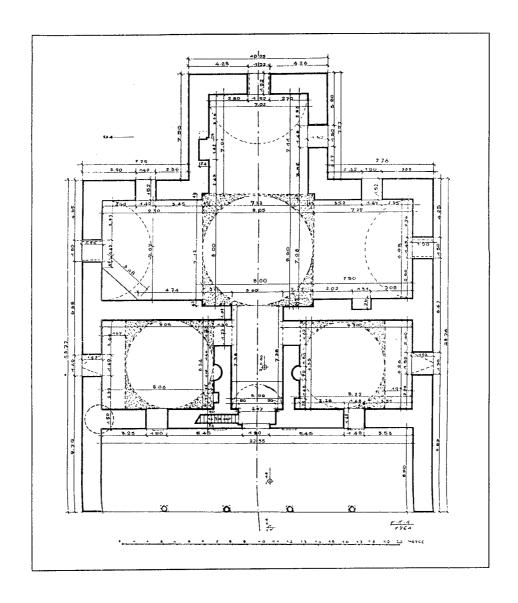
مسقط أفقي لمسجد مراد باشا في إستانبول (عن : كوران) .
